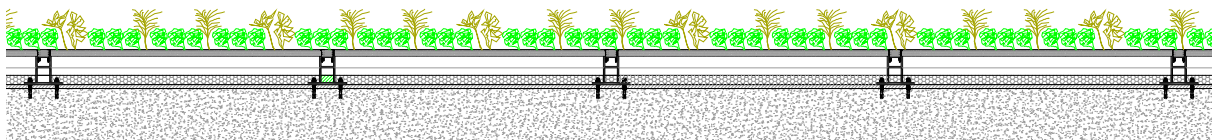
Planta tipo (pormenor) da aplicação de uma parede viva na habitação social do Porto (Desenho pelo autor)
